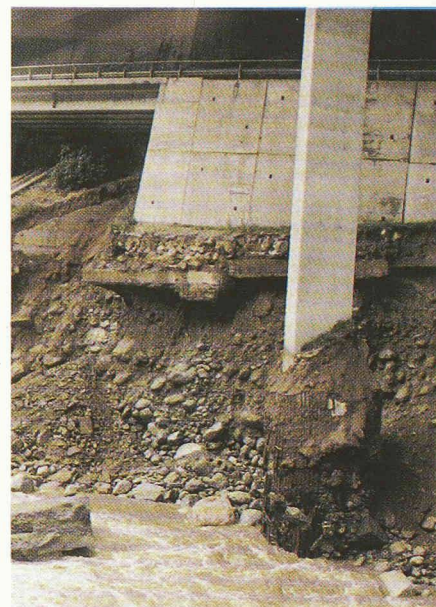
Puits de fondation affaissé, pile J vue du nord et le mur de soutènement/culée affouillés du viaduc de la route cantonale. (Photo: T. R. Schneider, 1877/19A.)
